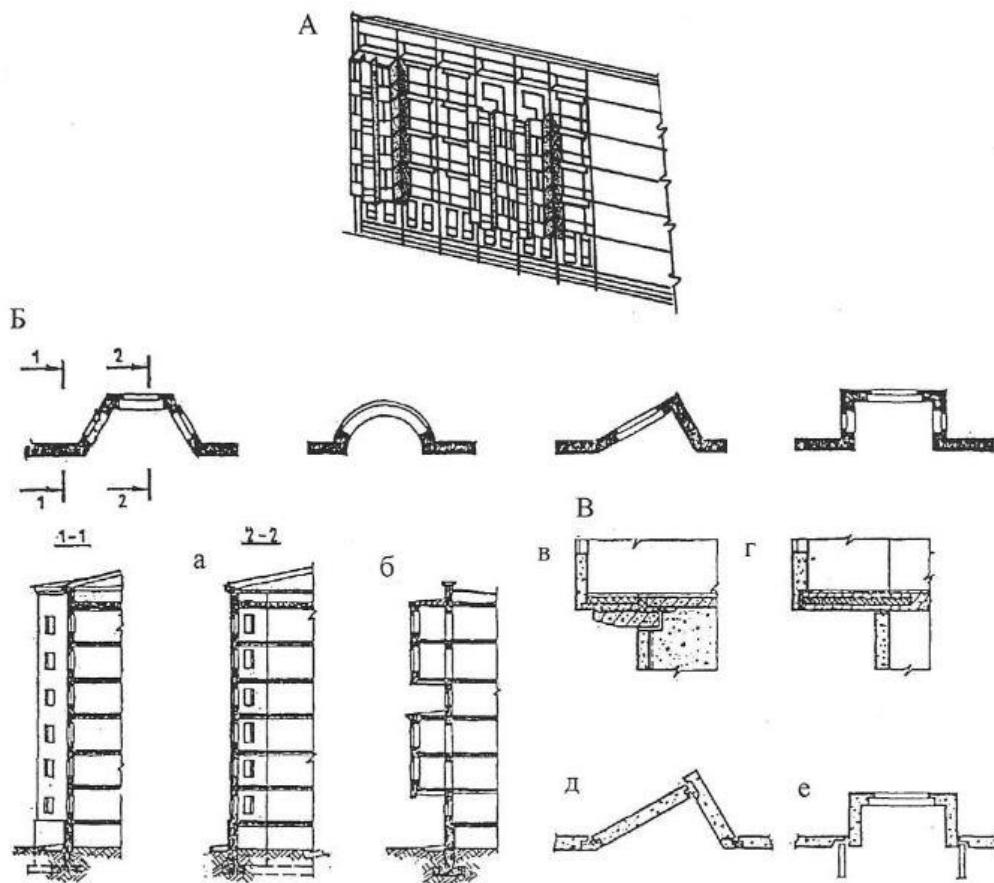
Эркеры: А – элемент фасадной плоскости с эркерами; Б – формы эркеров; В – схемы конструктивных решений; а – несущего эркера; б – навесного; в – опирания эркера на консольные балки; г – на консоль панели перекрытия с утепляющей прослойкой; д – эркер из стеновых панелей; е – то же, из объемного элемента
